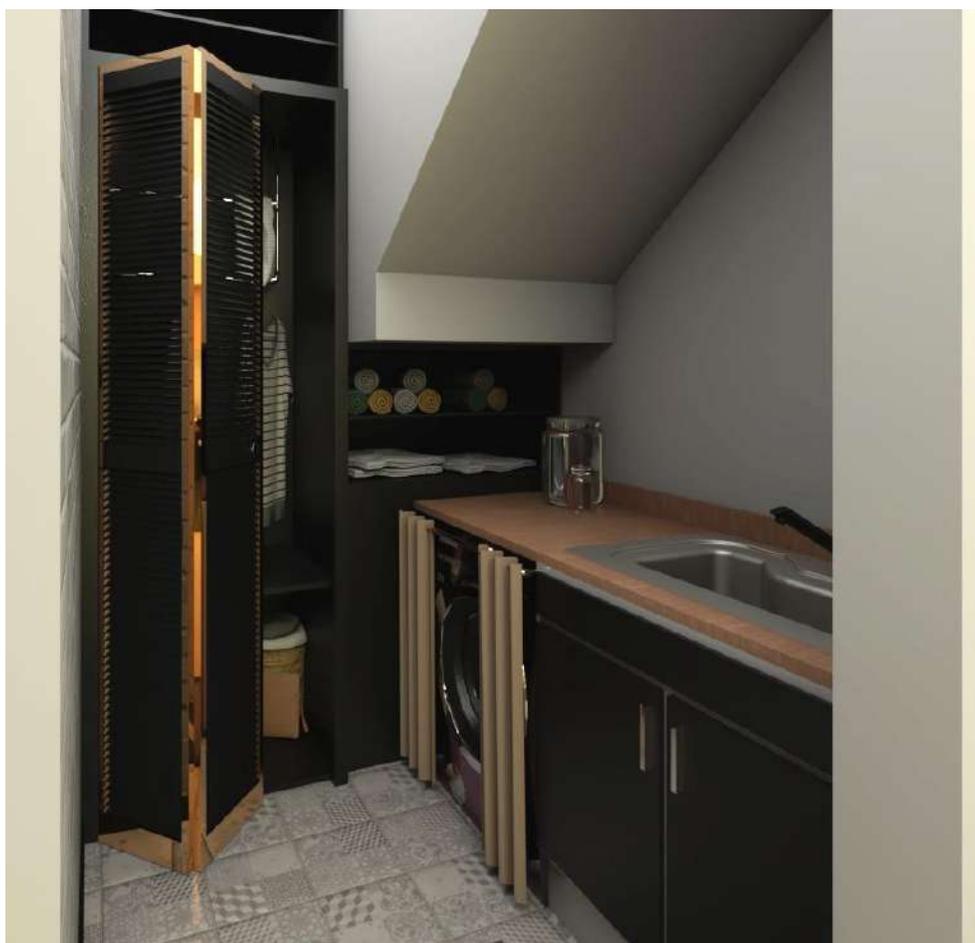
Vistas en perspectiva de la lavandería del primer nivel. Fuente: Propia.
